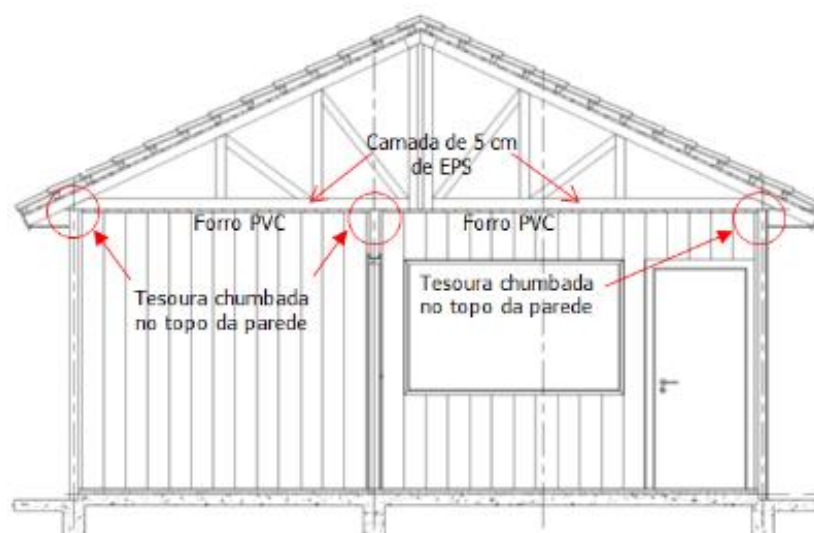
Corte transversal de unidade habitacional com sistema de cobertura constituído de forro de PVC com camada de EPS e telhado com estrutura metálica. (Sem escala).
